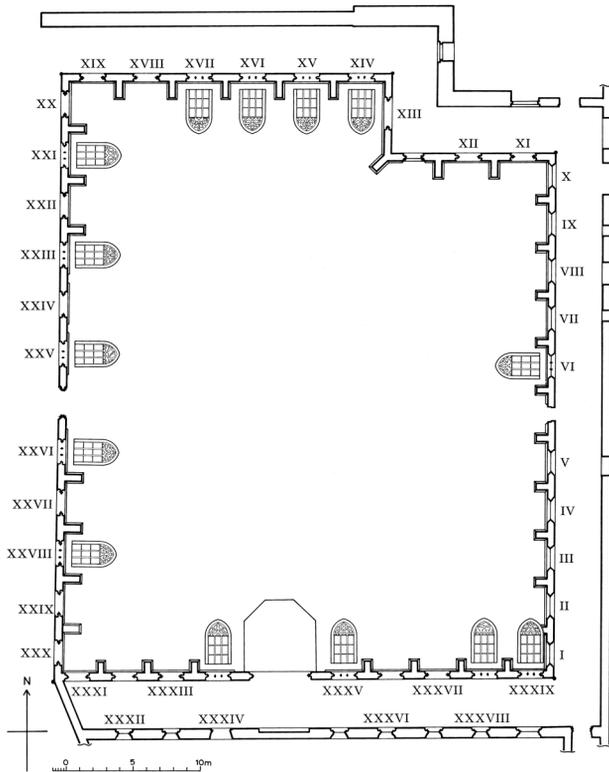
Hirsau, Kloster, Grundriss des Kreuzgangs mit Fensterschemata.
